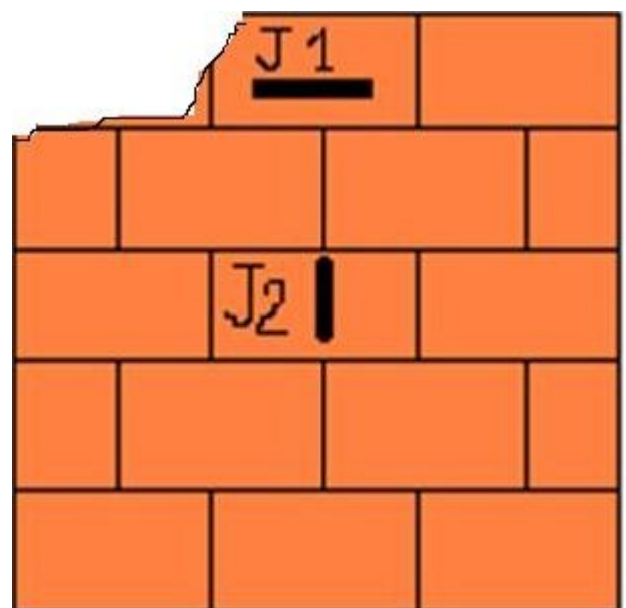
Rupture mur 8 trous de l'essai n°3.
